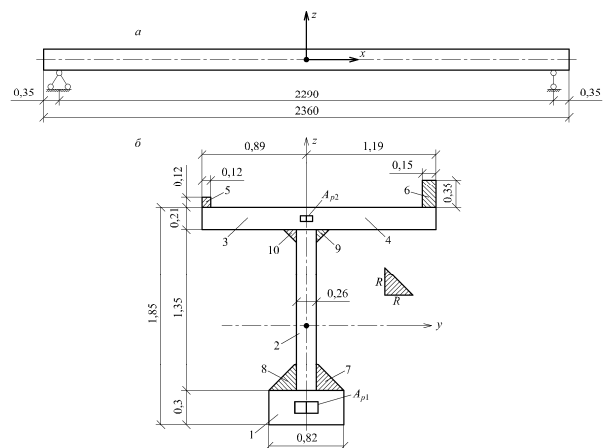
Конструкция железобетонного пролетного строения 22,9 м:
